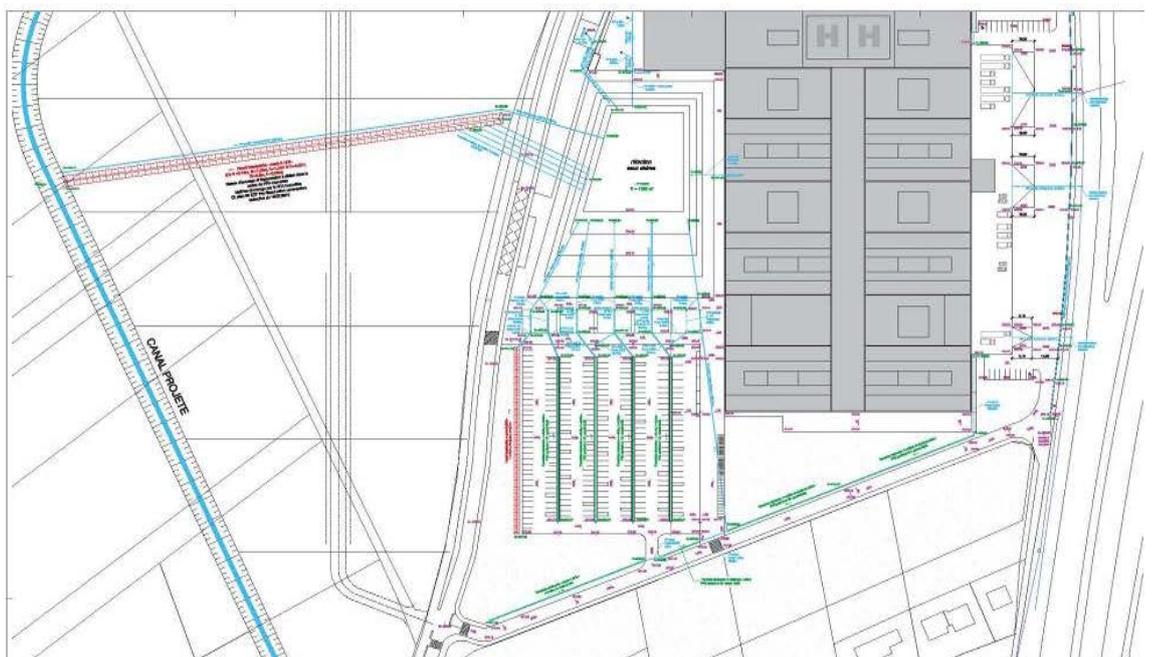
Gestion des eaux de surface, Hôpital Riviera-Chablais (Bureau Willi, plan n° 3600-001 du 09.12.2011)
